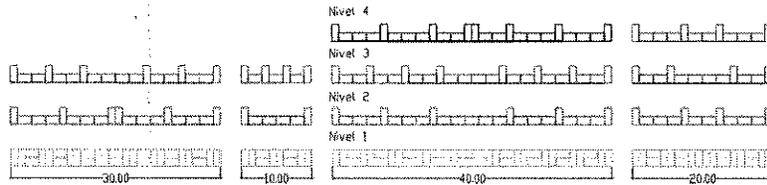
Detalles de los niveles que conforman la estructura de gavión sobre la Margen Derecha de la Quebrada Huila. Fuente Propia.
